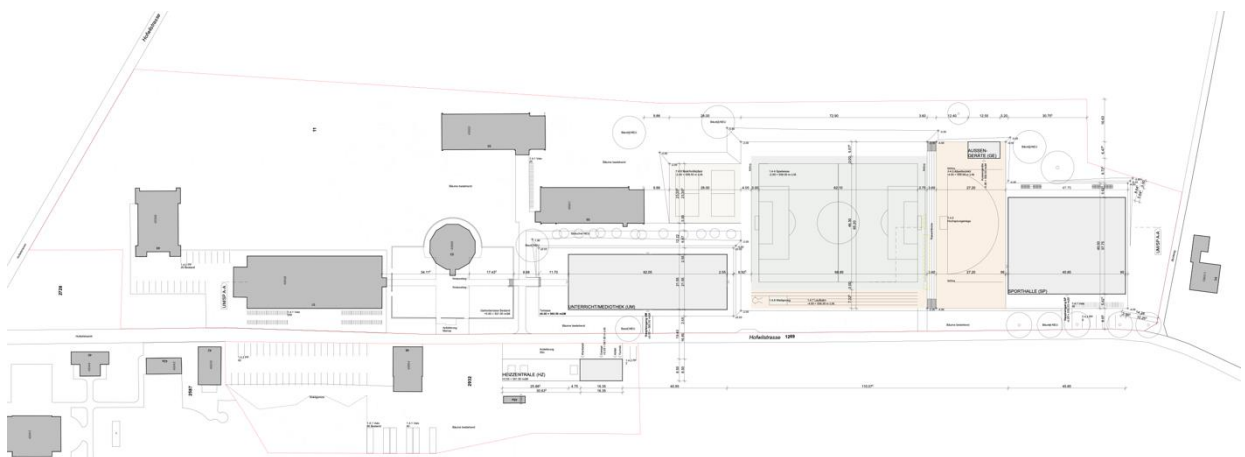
Situationsplan, hellgraue Flächen: Neubauvorhaben wie Schulhausneubau (Unterricht, Mediothek), Ersatzneubau der Sporthalle, Aussensportanlagen; dunkelgraue Flächen: bestehende Gebäude, Stand 28.05.2021, AGG des Kantons Bern
